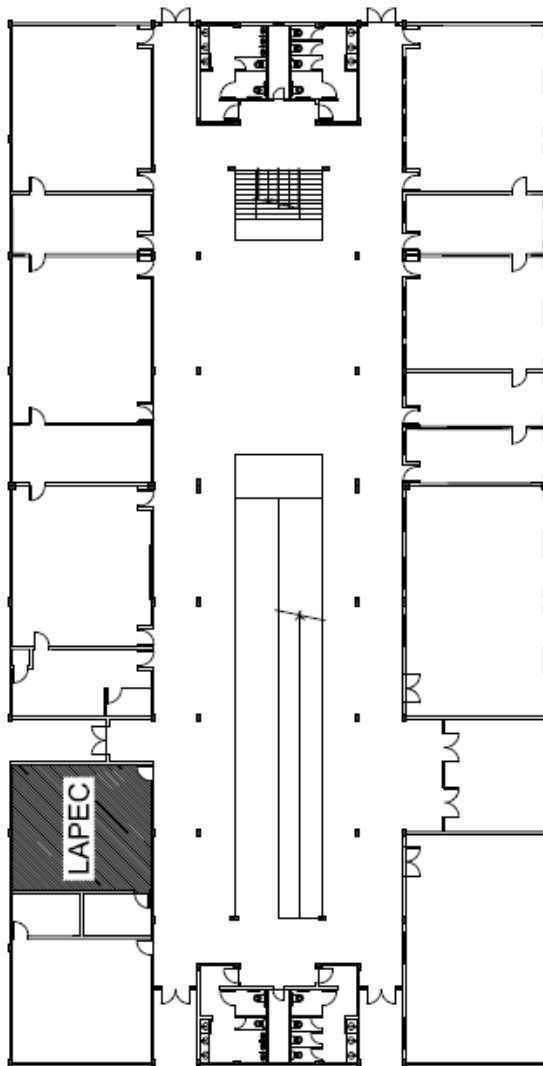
Planta baixa do prédio acadêmico do campus Vila Velha. Em destaque o LAPEC.
